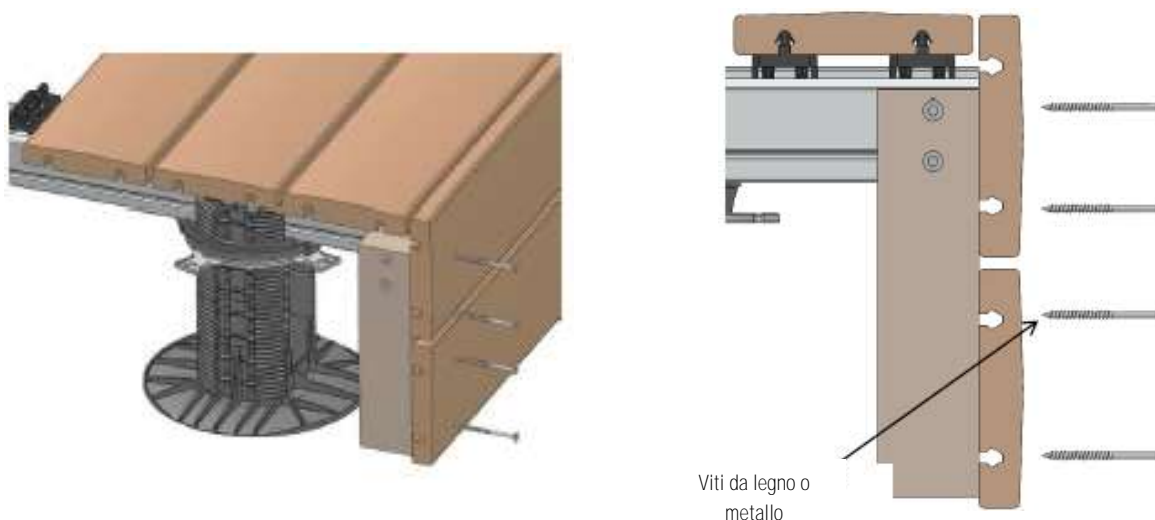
e 14: in alto. Sezione e vista relative alla posa a vista di elementi perimetrali per sottostruttura ad altezza fissa (foto Grad™).
